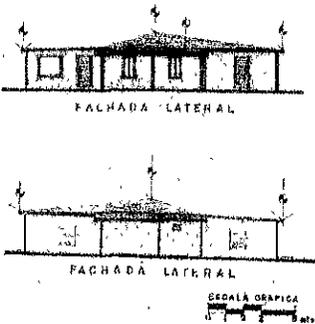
Fachadas laterales Este y Oeste, caso 15
